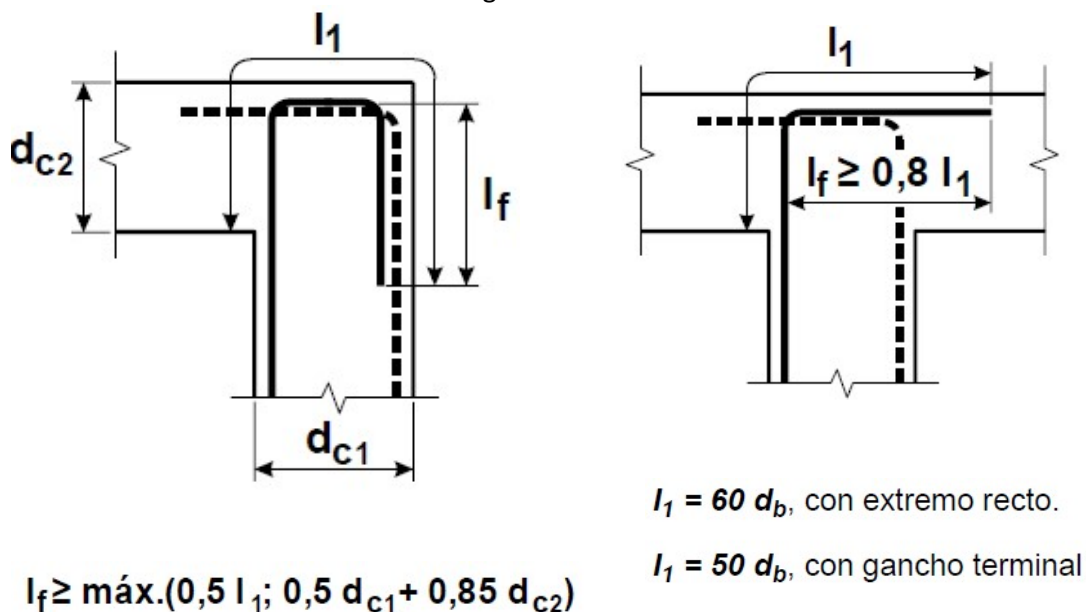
Detalle de anclajes de encadenado vertical y encadenado horizontal superior en L y en T -CIRSOC 103
